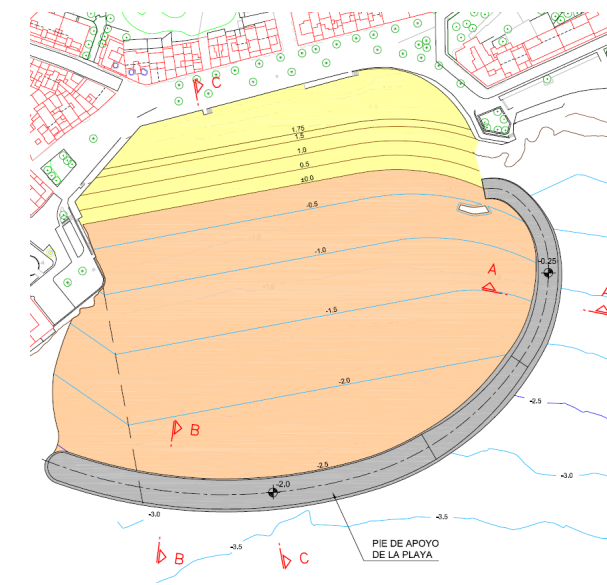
Planta de la Variante 1 de la alternativa 2 (Fuente: Elaboración propia)
